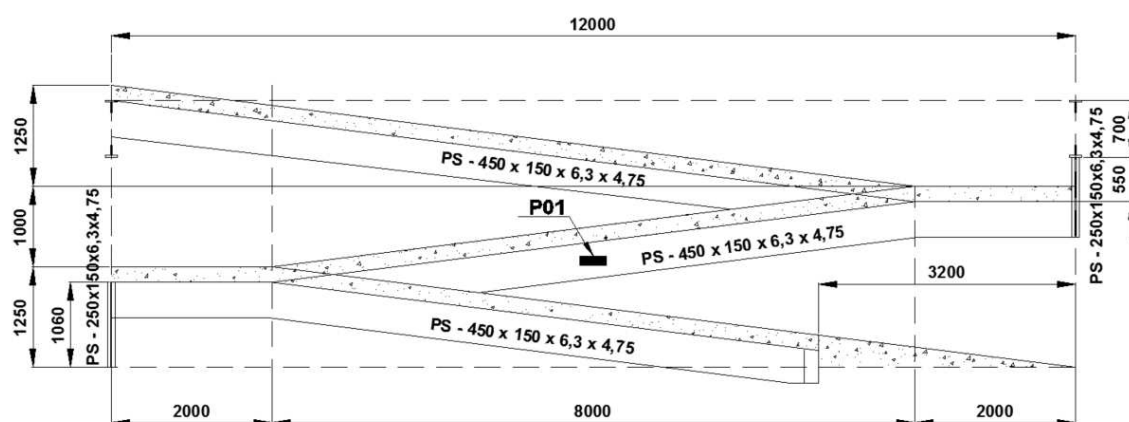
Elevação eixo D, com o posicionamento do acelerômetro.
